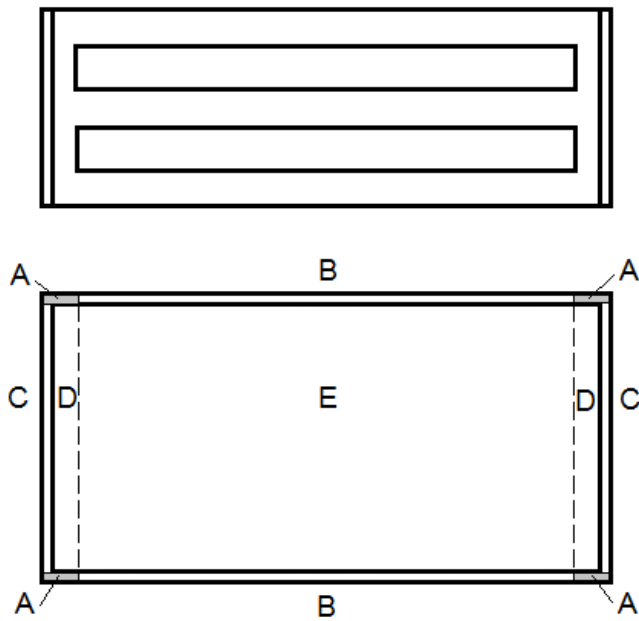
Bloco de concreto da Proposta #24 dividido em seções.
